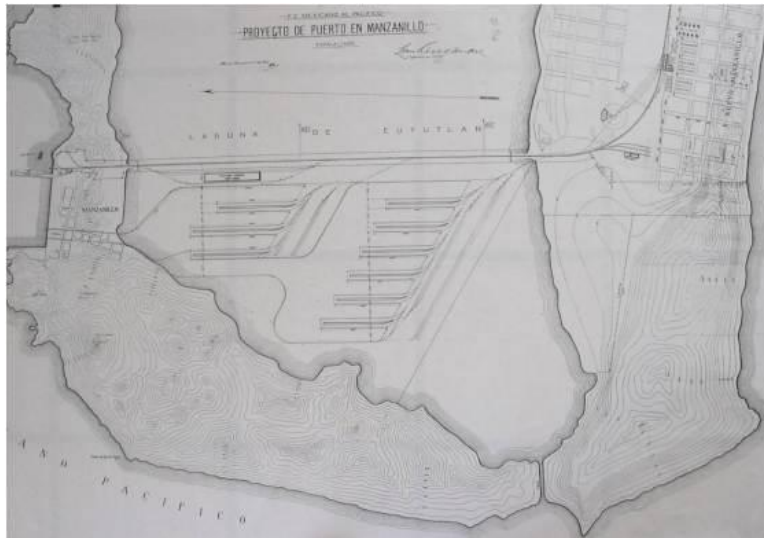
Fracción de plano para proyecto, 1908 (Mendoza Pérez, L. A. 2008).
